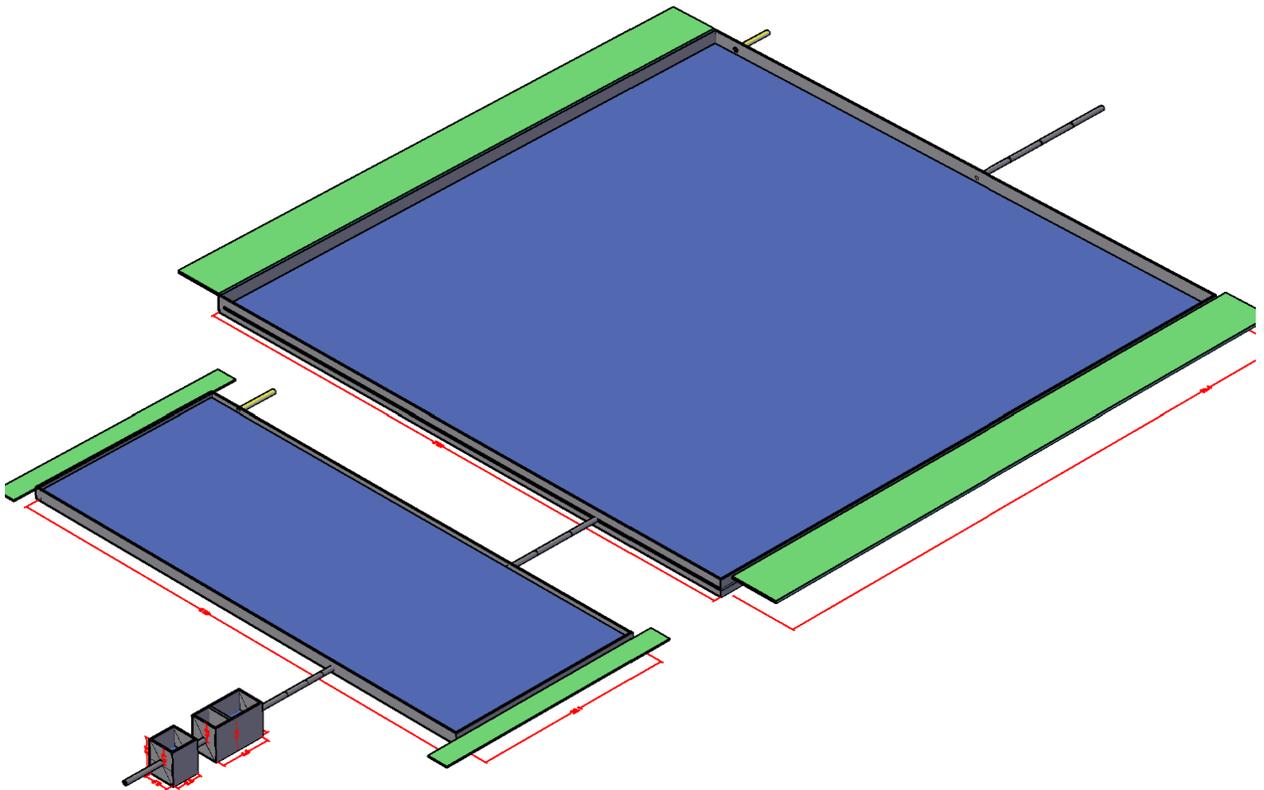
PTAR vista conceptual SO. Fuente: creación propia
